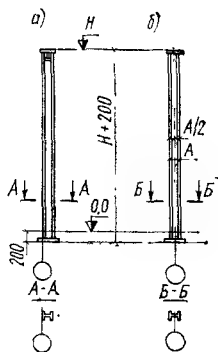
Колонны из одного двутавра для бескрановых зданий
